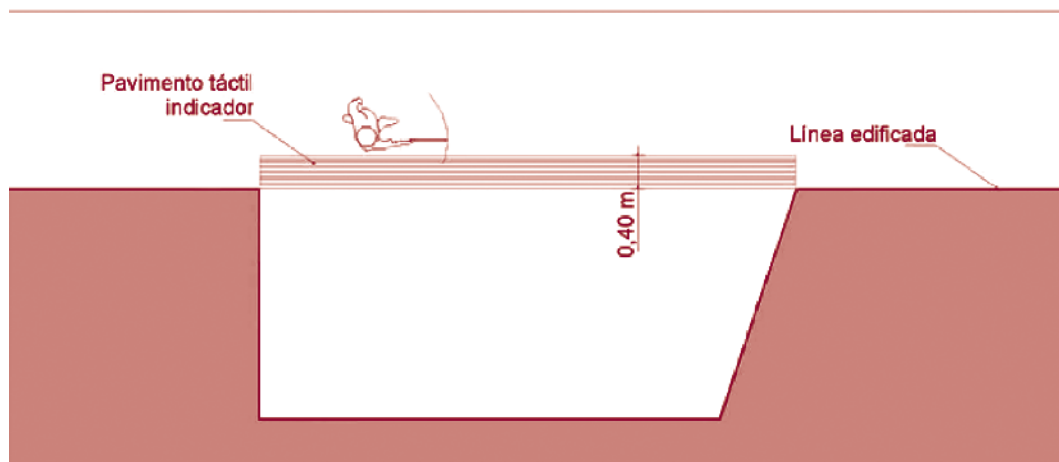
/ Franja guía de pavimento táctil que reconstruye la línea de fachada
